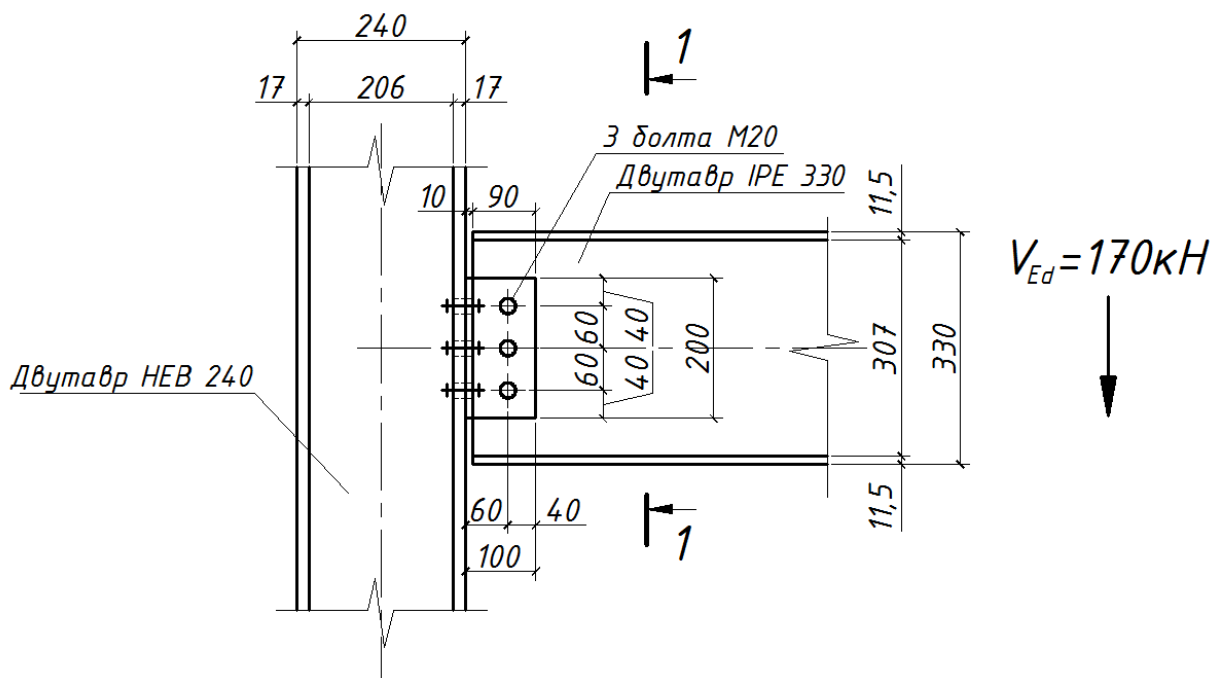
Схема узла крепления балки (двутавр IPE 330) к колонне (НЕВ 240)
